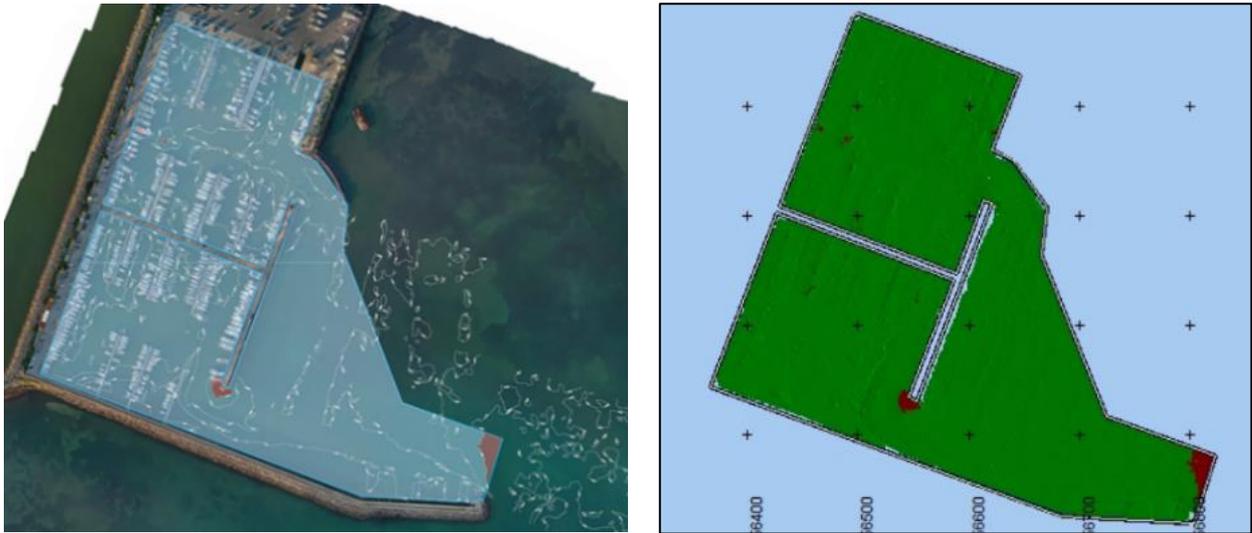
Aree interessate dall'escavo (in azzurro e in verde).
